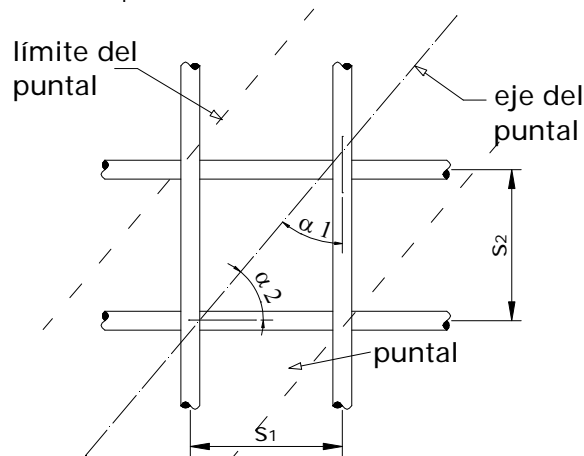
Refuerzo que cruza un puntal (Adaptada de ACI 318-11)
